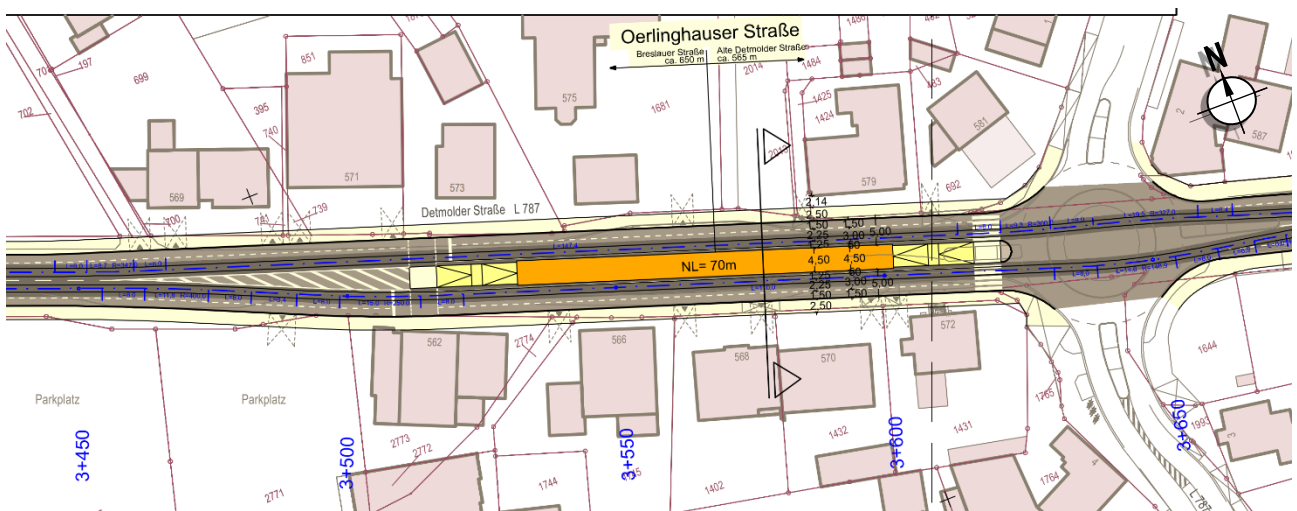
Trassenvariante 1 – Lageplan Ortsdurchfahrt Hillegossen
